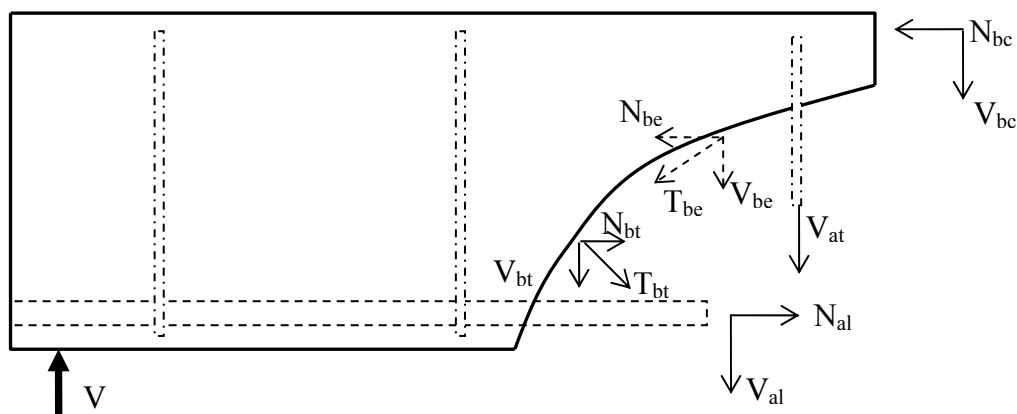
Forces internes au travers d'une fissure inclinée (poutre avec armatures transversales)
